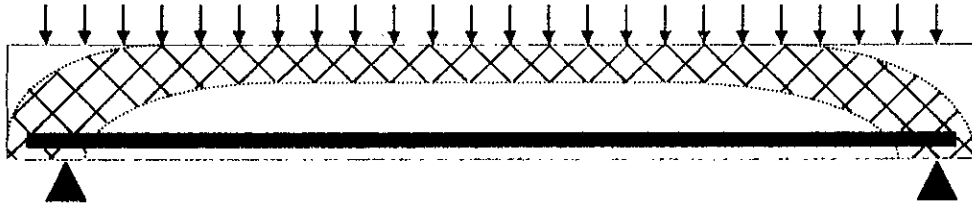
Comportement structural de la poutre sans armatures d'effort tranchant.
